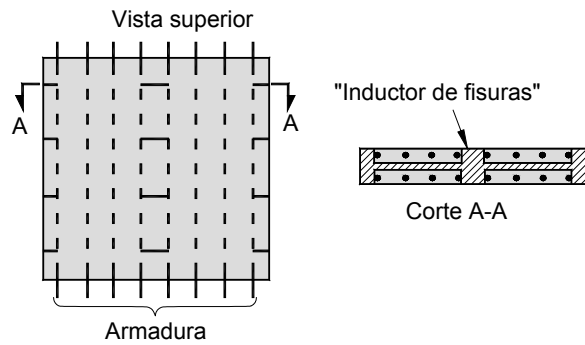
Ejemplo de un elemento utilizado para ensayar a tracción anclajes instalados en hormigón fisurado
